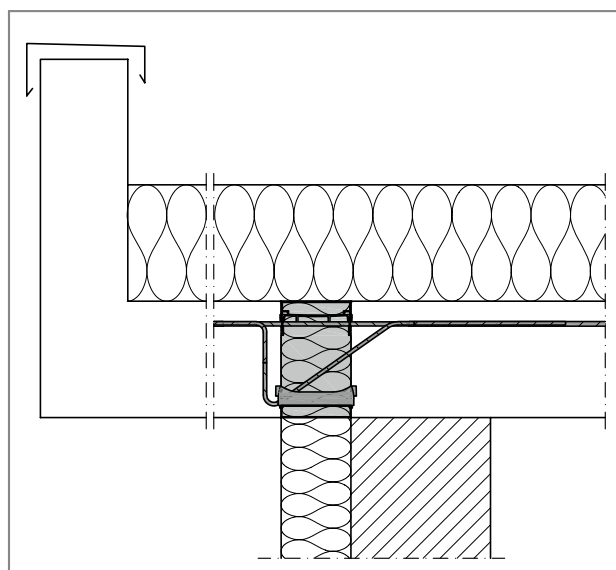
Schöck Isokorb® T Type K : Raccordement d'un auvent
